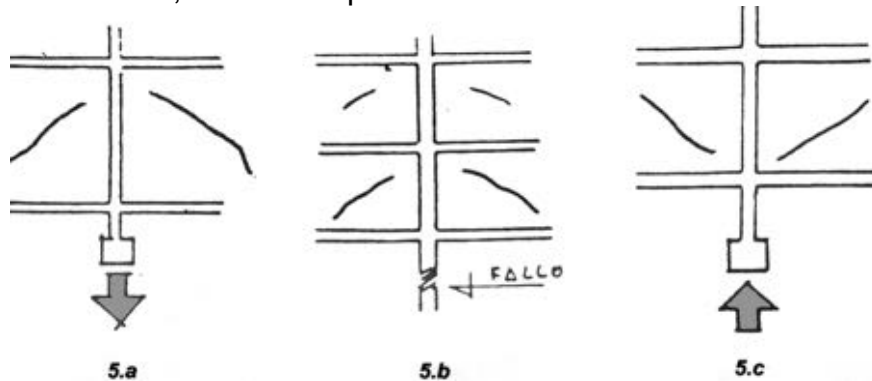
FISURAS POR ROTURA DEL MARCO POR TRACCIÓN
